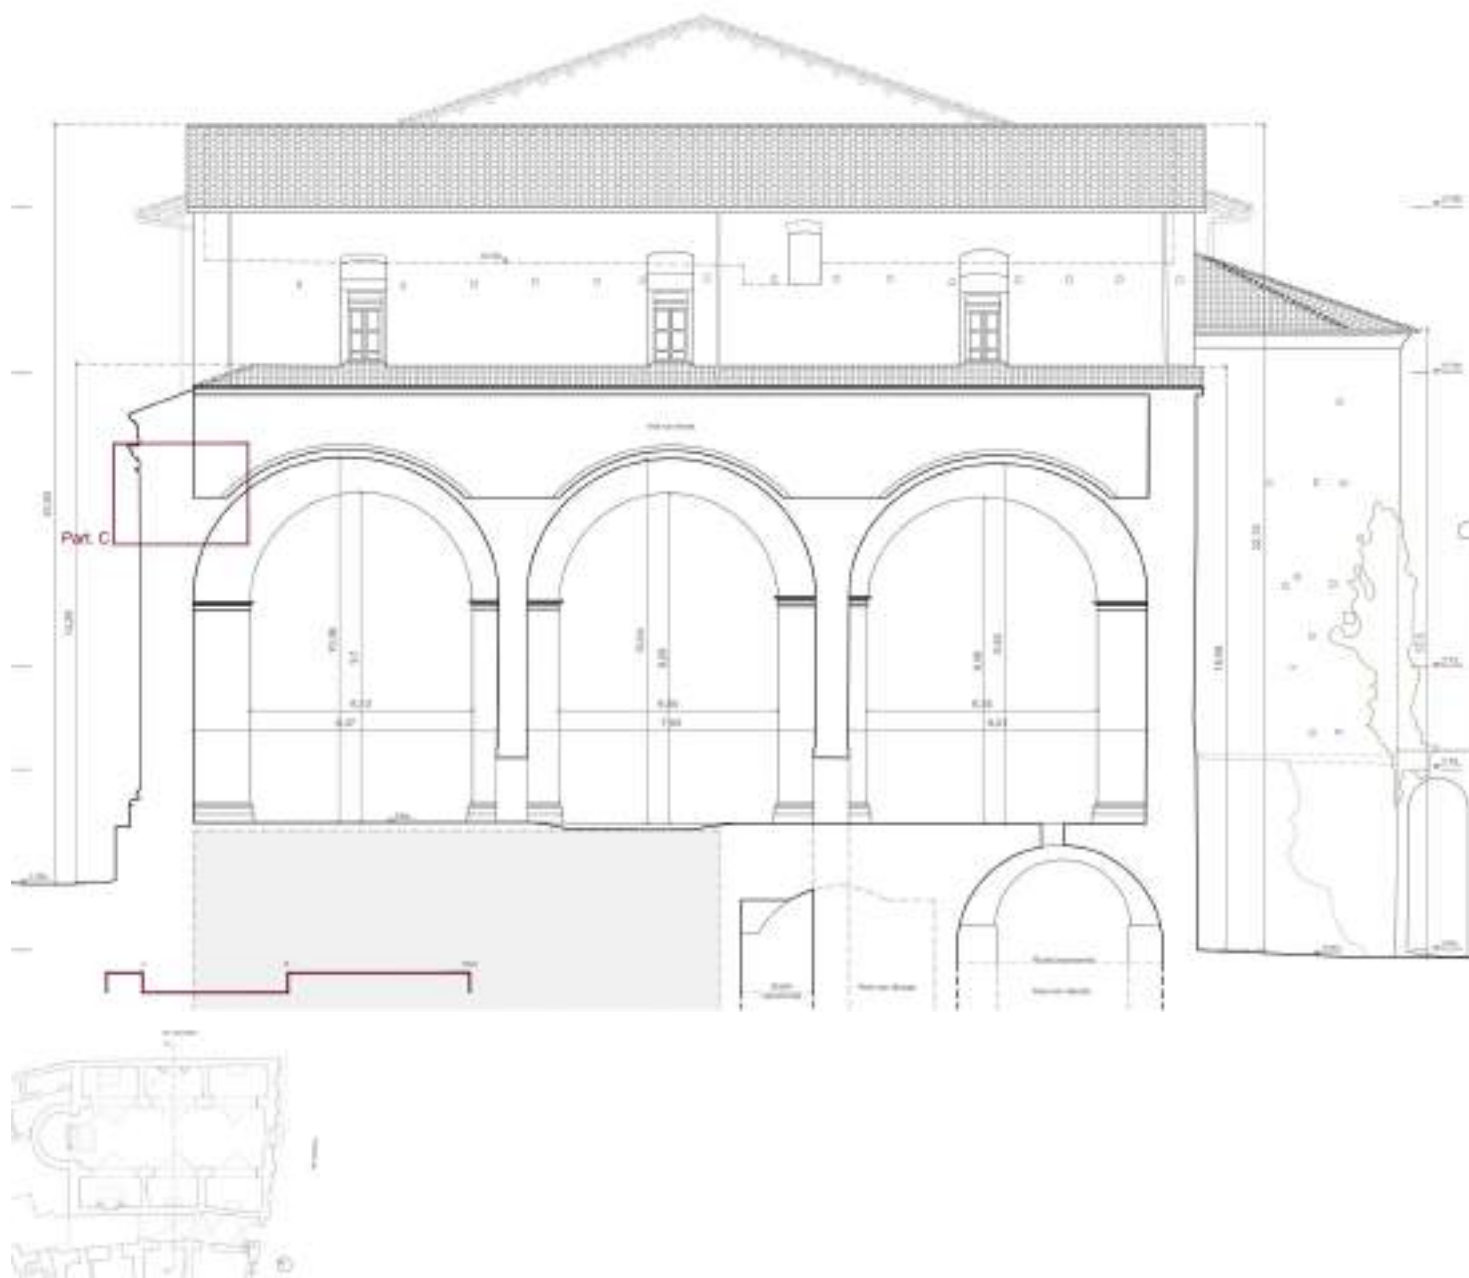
/ Sezione longitudinale DD'. (Particolare cfr. p. 87).
